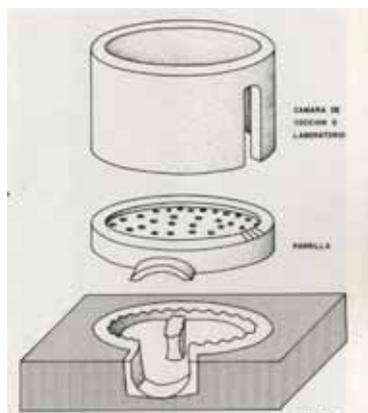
Planta y reconstrucción del Horno de la Casa Grande (según Broncano y Coll, 1988)
